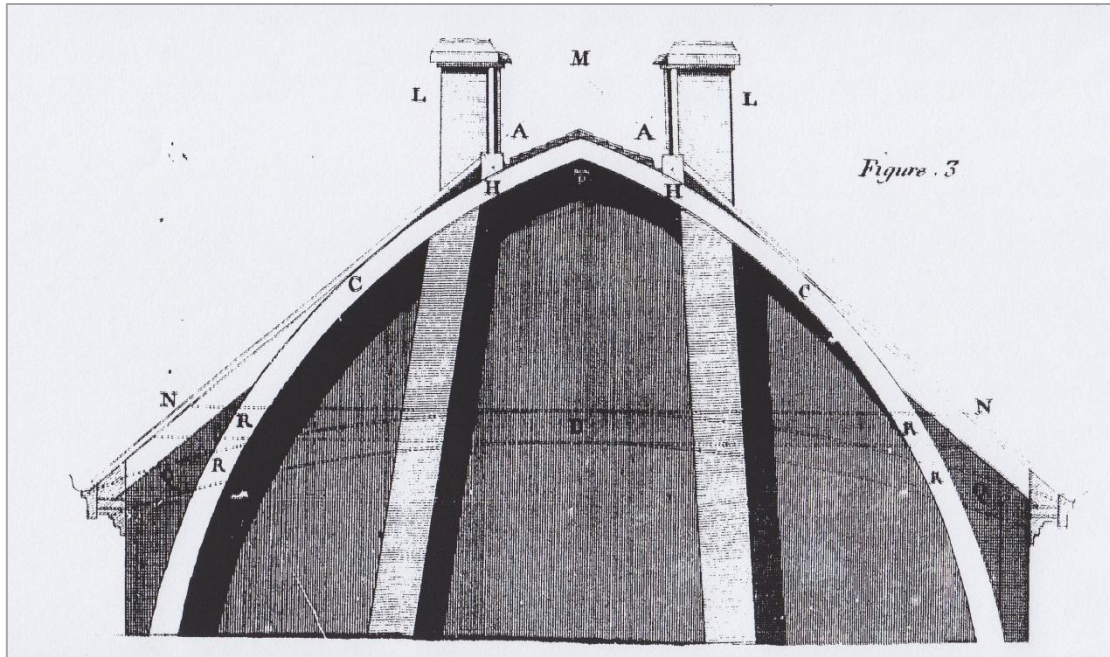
Aménagement d'une plateforme sur le toit pour faciliter le ramonage.
